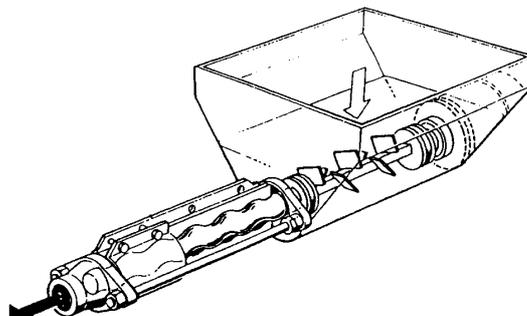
Betonpumpen für Nassspritzbeton [4]
